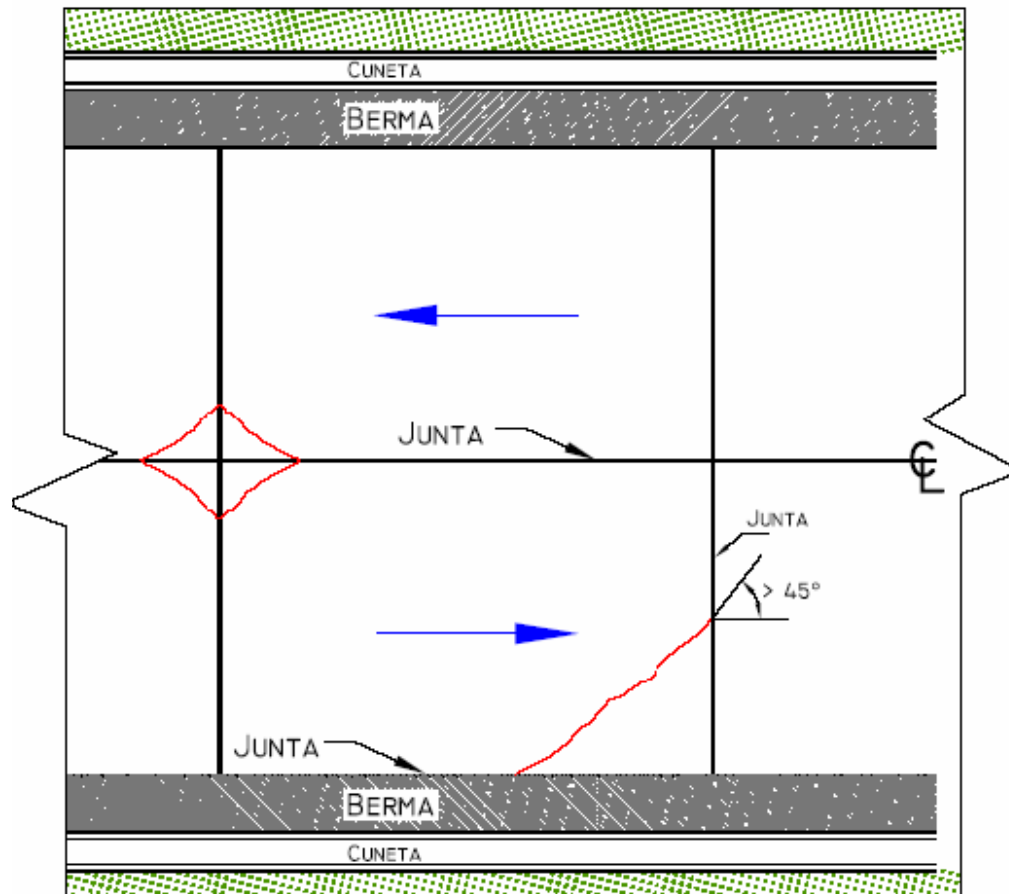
Vista en planta: Grieta de Esquina
